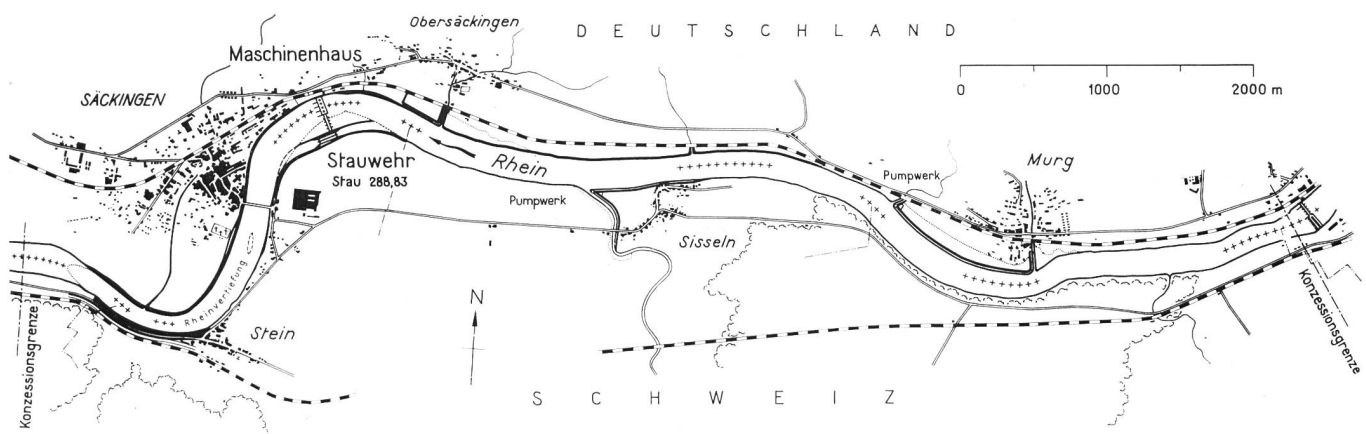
Übersichtslageplan des Kraftwerkes Säckingen
